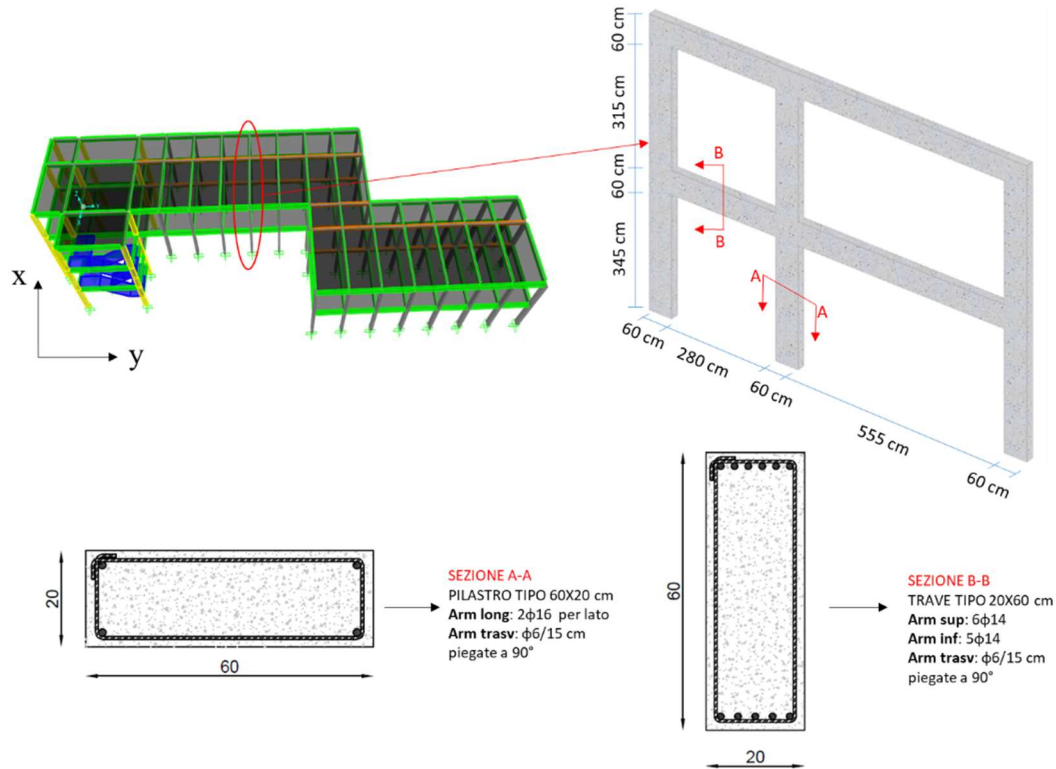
Dettagli costruttivi delle sezioni di travi e pilastri.
